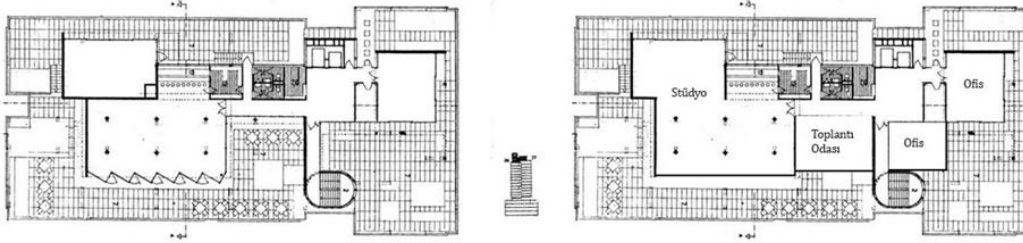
Hukukçular Sitesi- Açık plan yaklaşımının izin verdiği farklı plan alternatifleri ¹⁶¹
